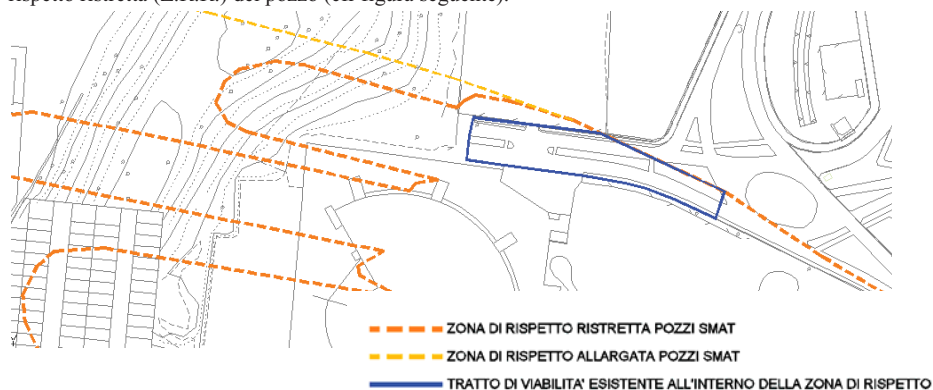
Stato attuale dell'area - perimetrata in blu la porzione di viabilità esistente, non in uso, ricadente all'interno della zona di rispetto ristretta dei pozzi SMAT
